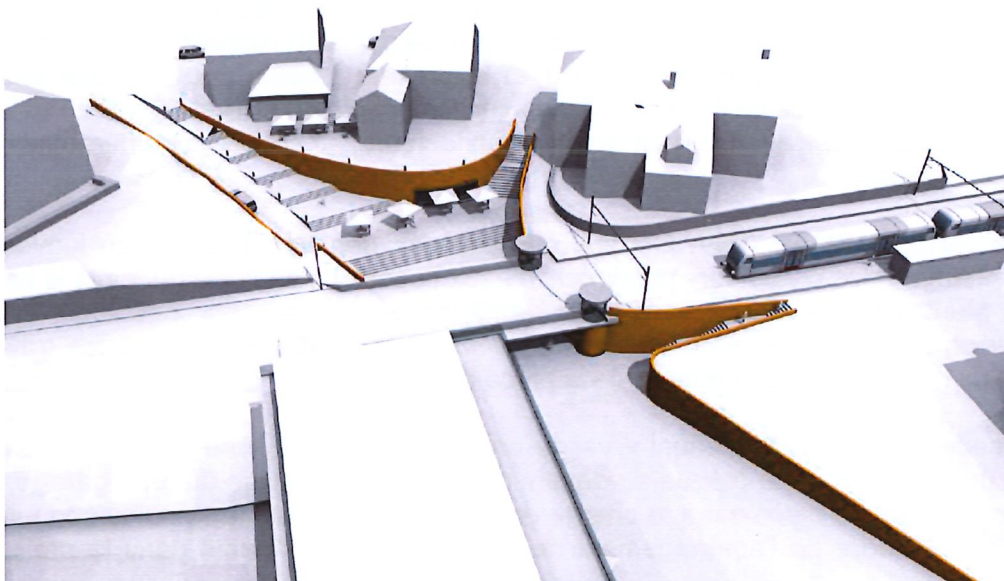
place de rebroussement, extrait « PQ Pré-Jaquet »
